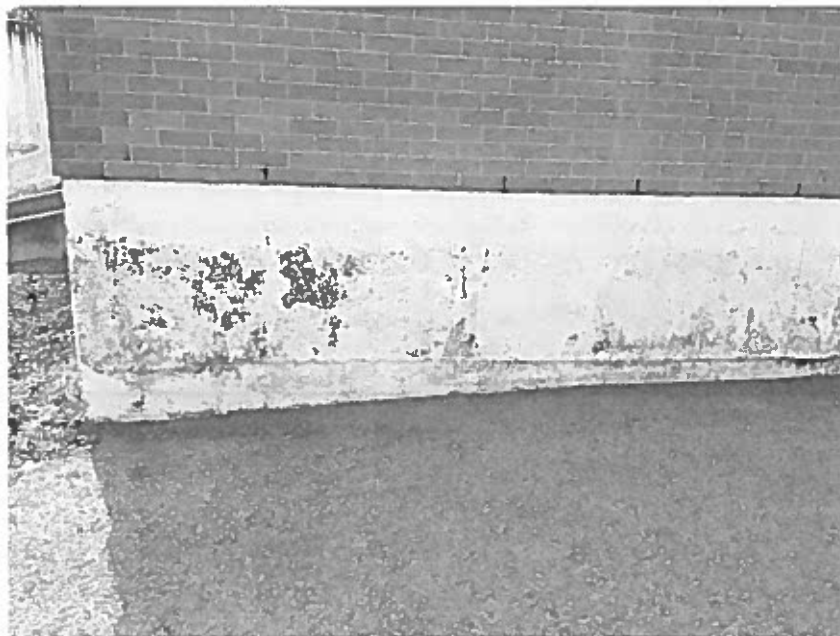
Extérieur – Peinture sur béton de mur avec contamination fongique (échantillon VR-1)
